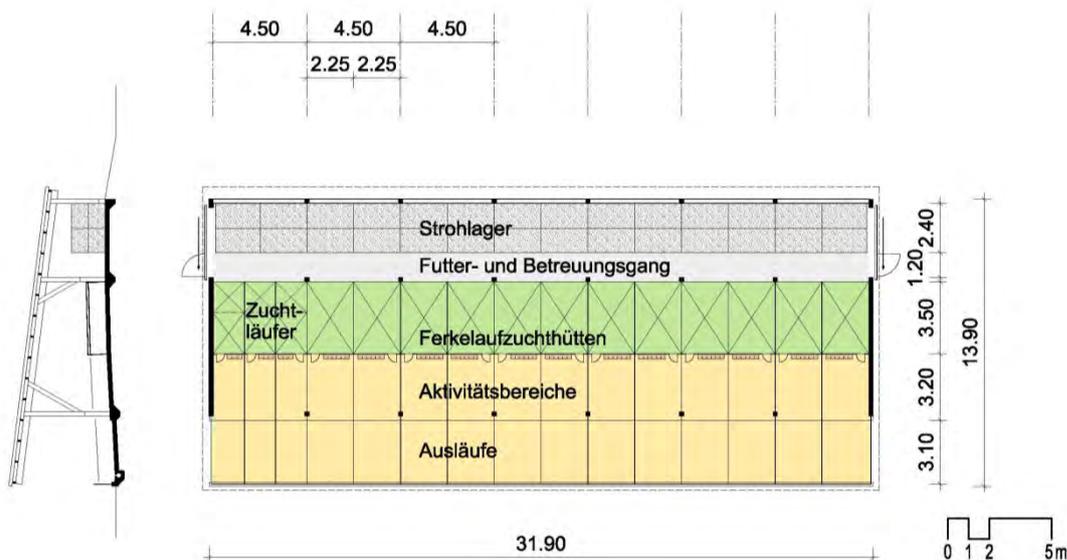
Grundriss und Schnitt des Ferkelaufzucht-Stallabteils
